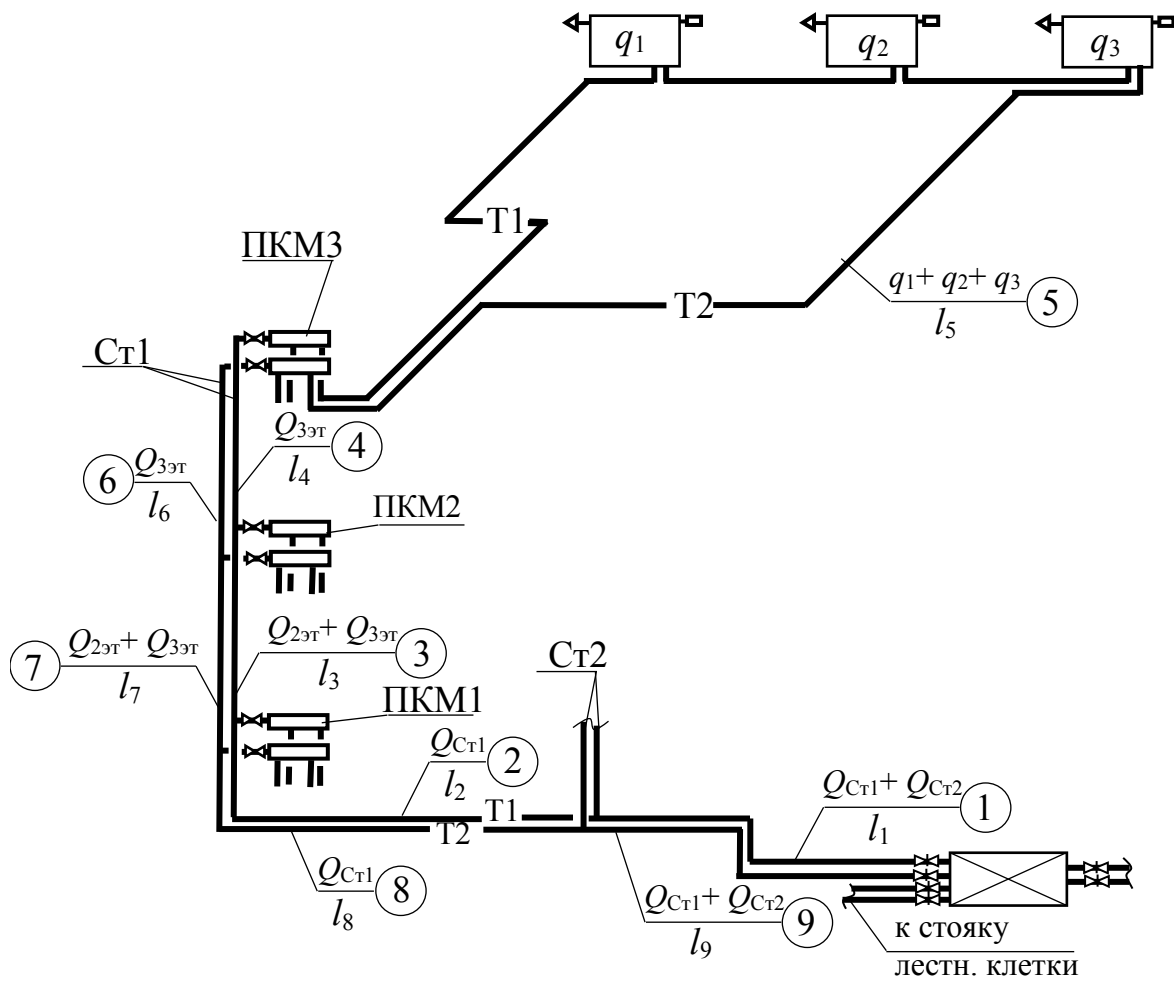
Расчетная схема однотрубной квартирной разводки
